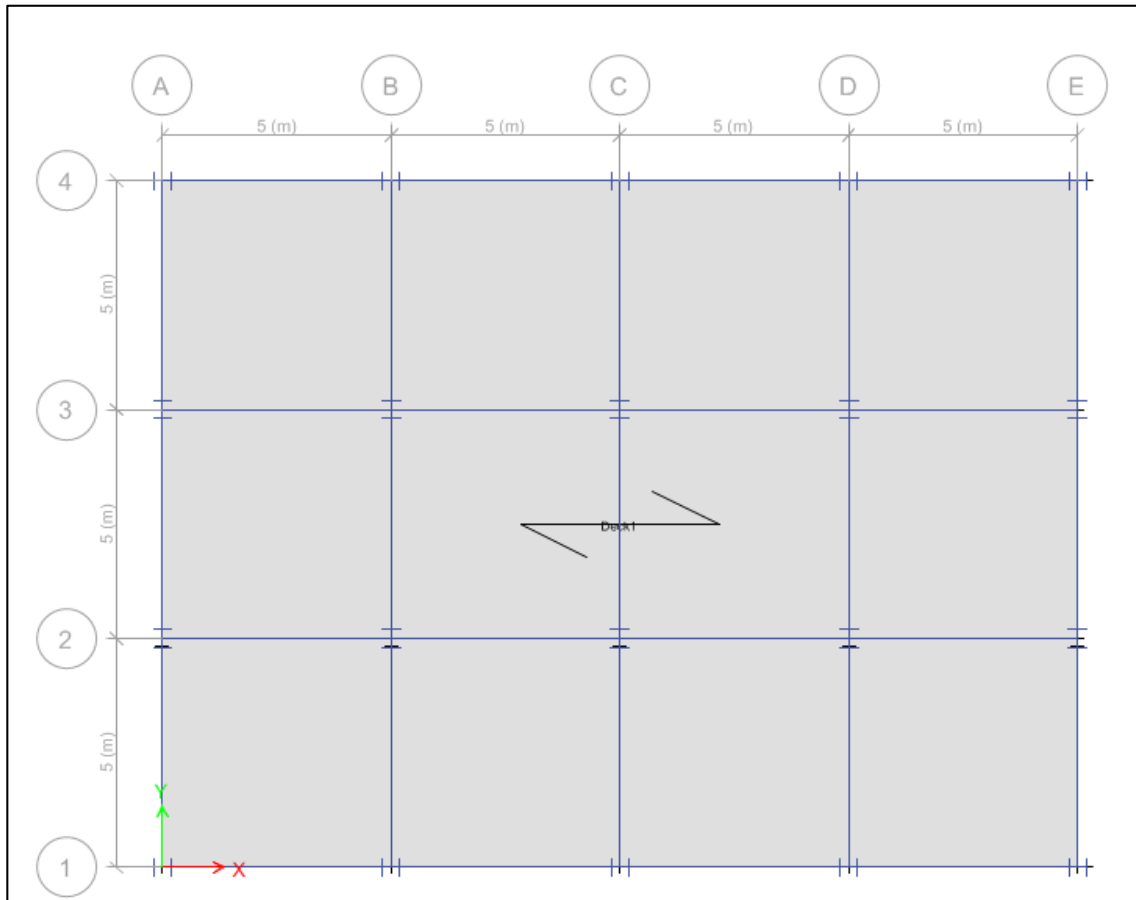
Configuración en Planta de la Estructura de Análisis.
